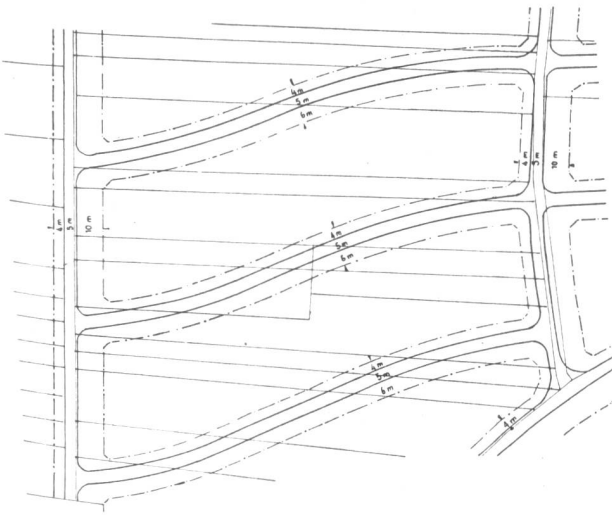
Ausschnitt aus dem Ueberbauungsplan Oberburg-Moos-Letten mit der alten Parzellierung und den projektierten neuen Wegen.
